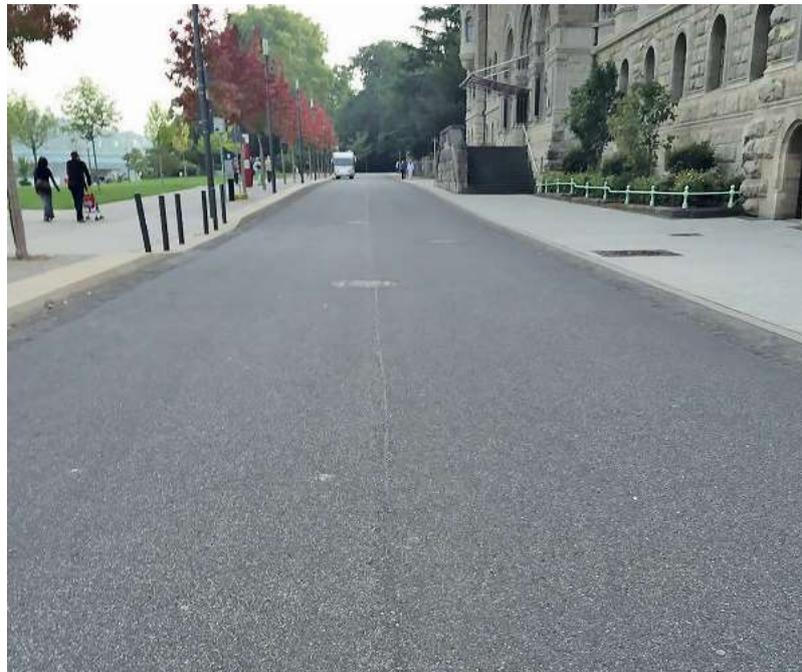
Dunkle Walzasphaltdeckschicht am Konrad-Adenauer-Ufer in Koblenz
